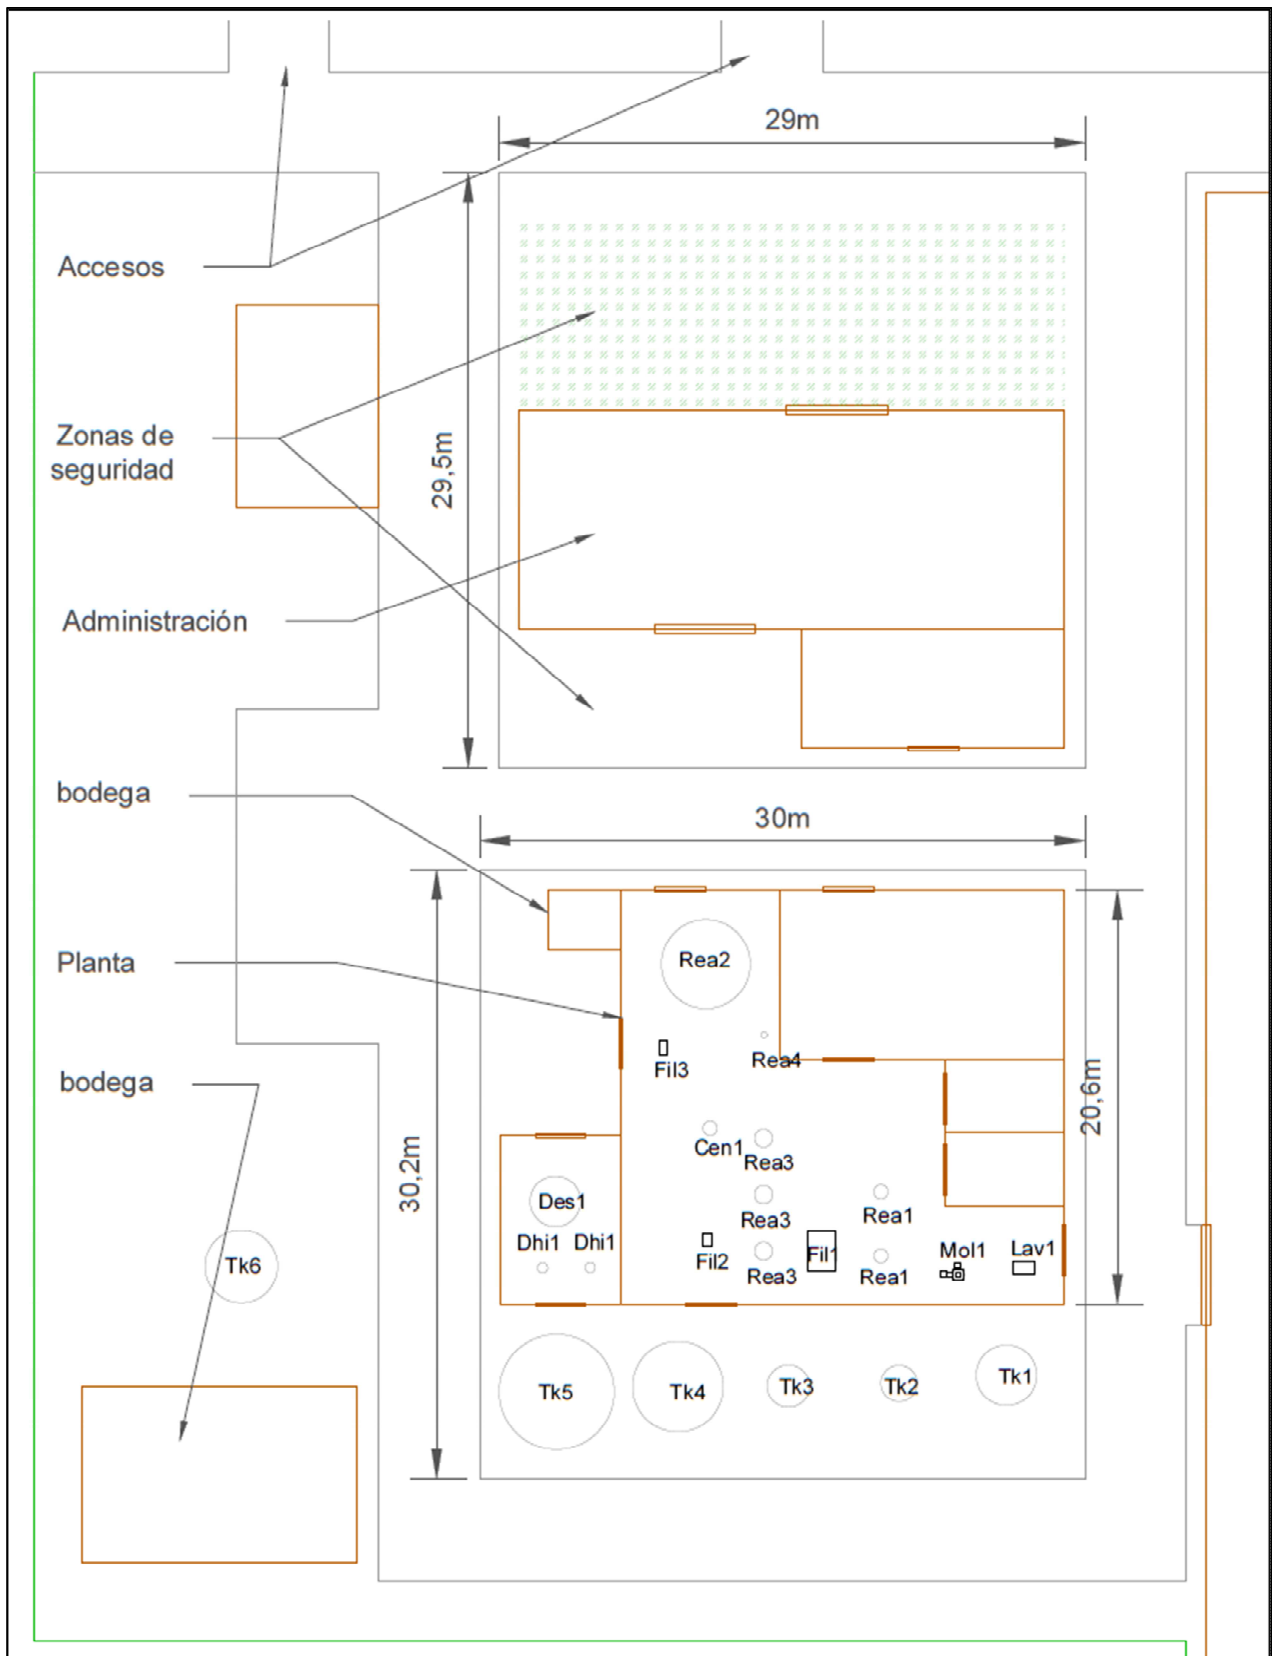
Layout de la planta (excluyendo bodega de rastros)
